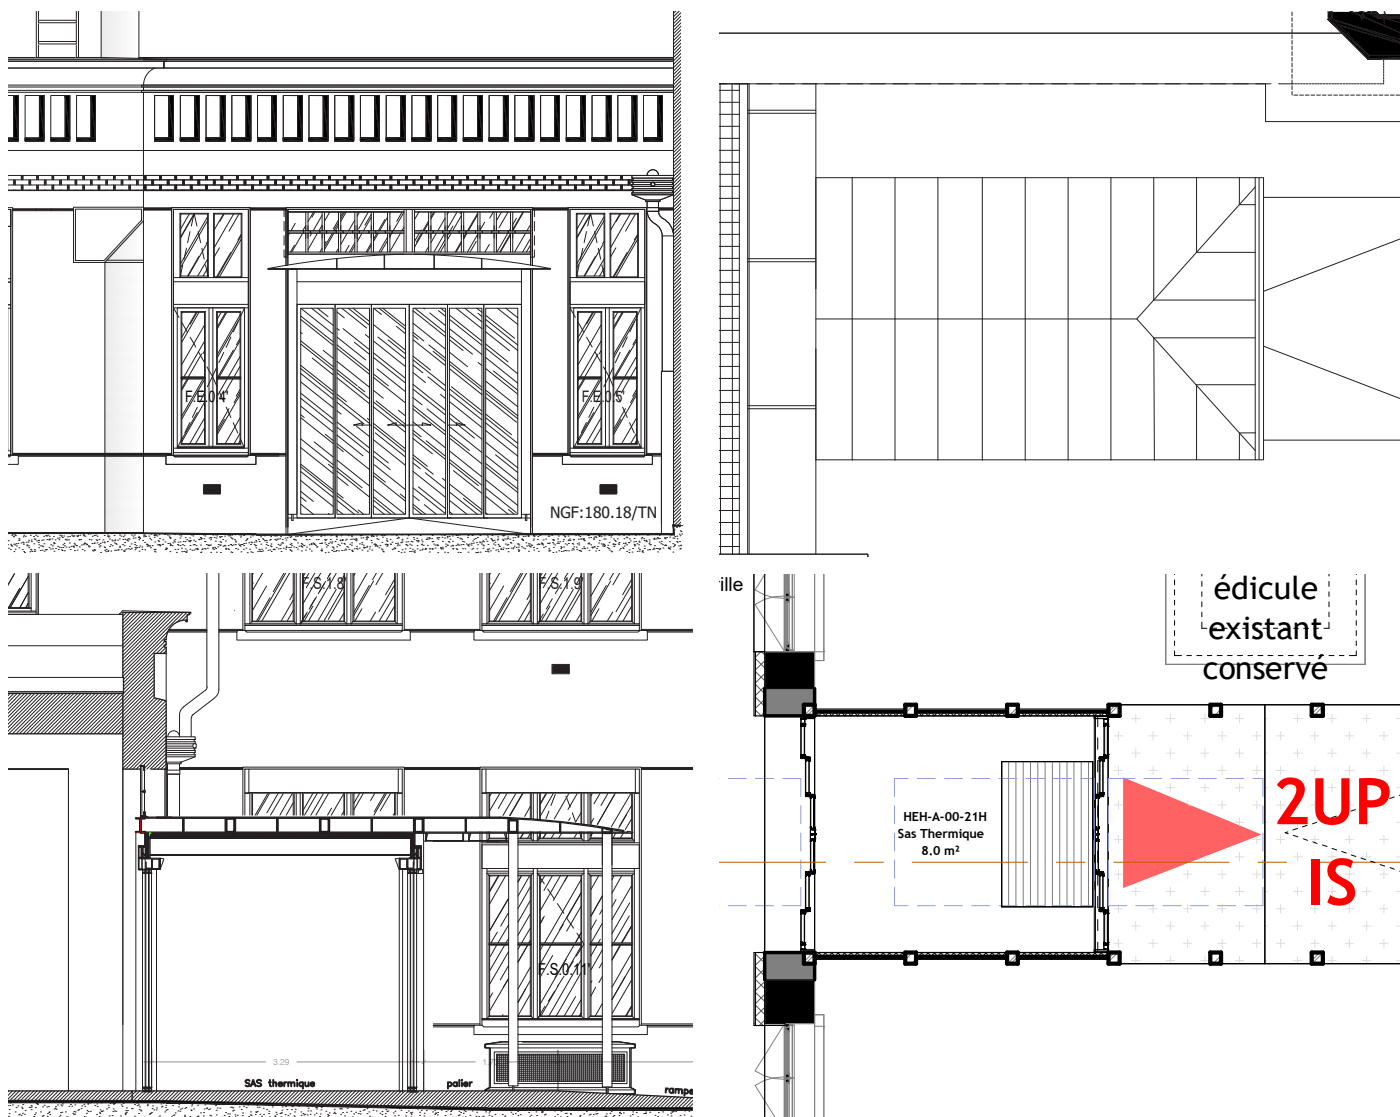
État projeté (APD) du lot Gros-œuvre - maçonnerie - pierre de taille, plans, coupe et élévation Est du SAS thermique, pavillon A, Agence Goutal, 2025.
